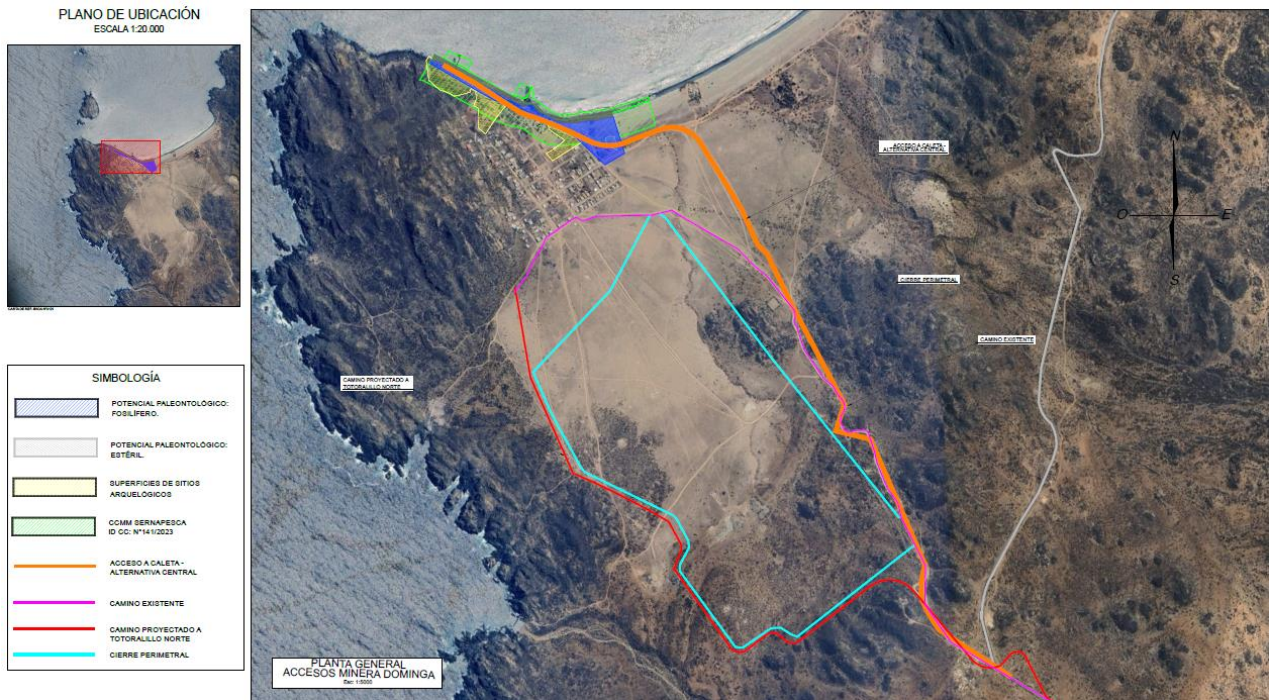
Planta general de Acceso Proyecto Minera Dominga (Camino proyectado con Trazado Rojo, alternativa central con naranja y camino existentes con Trazado magenta).
